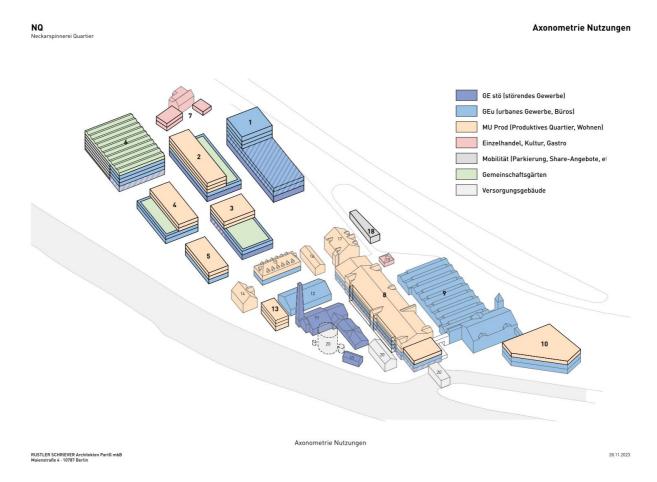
Axonometrie mit geschossweisen Art der baulichen Nutzung, Rustler Schriever Architekten, Berlin, 28.11.2023
